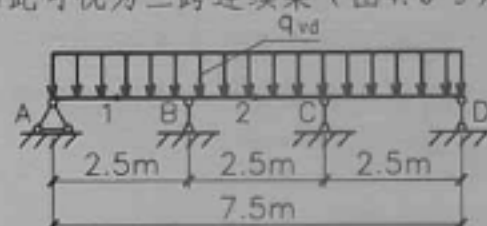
墙梁在竖向均布线永久荷载作用下的计算简图
